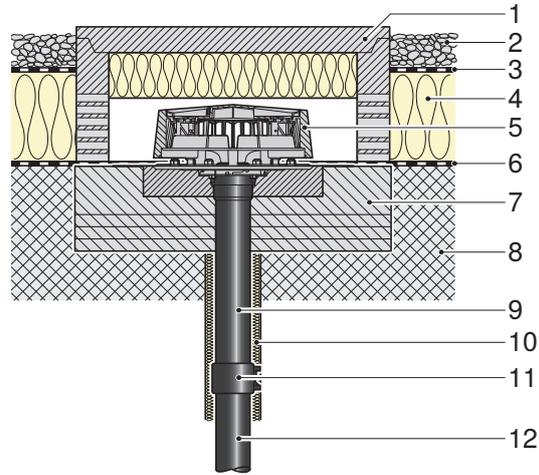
Монтаж на изолированной жесткой кровле (конструкция кровли: Инверсионная кровля) с кровельным покрытием, с гравийной засыпкой
